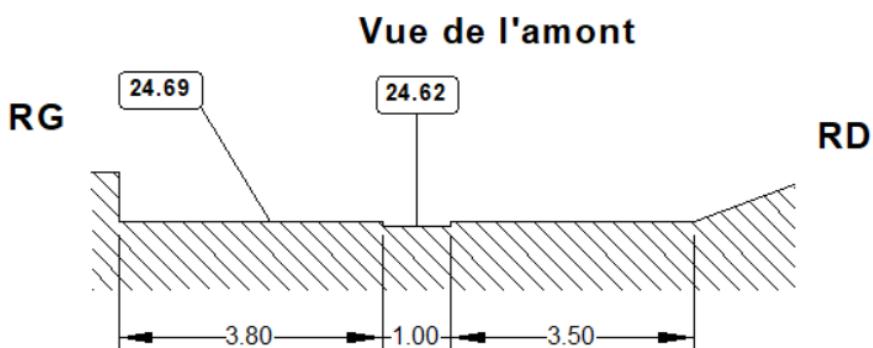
Coupe en travers de l'ouvrage des Pierres ferrées (source : MN'EAU)
